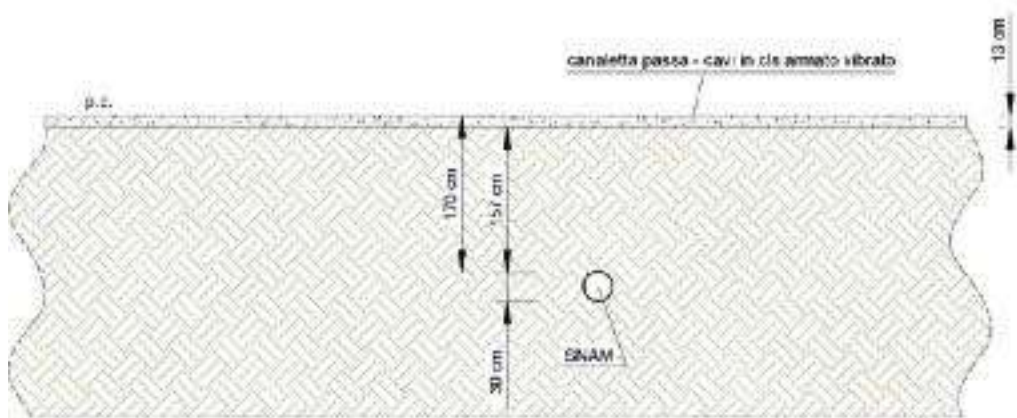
Schema dell'attraversamento della fascia di rispetto Snam con una canaletta passa-cavi in cls armato vibrato.
